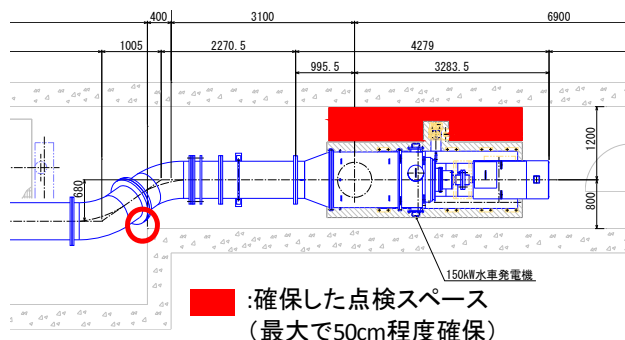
点検スペース確保に配慮した導水管の配置（平面図）
